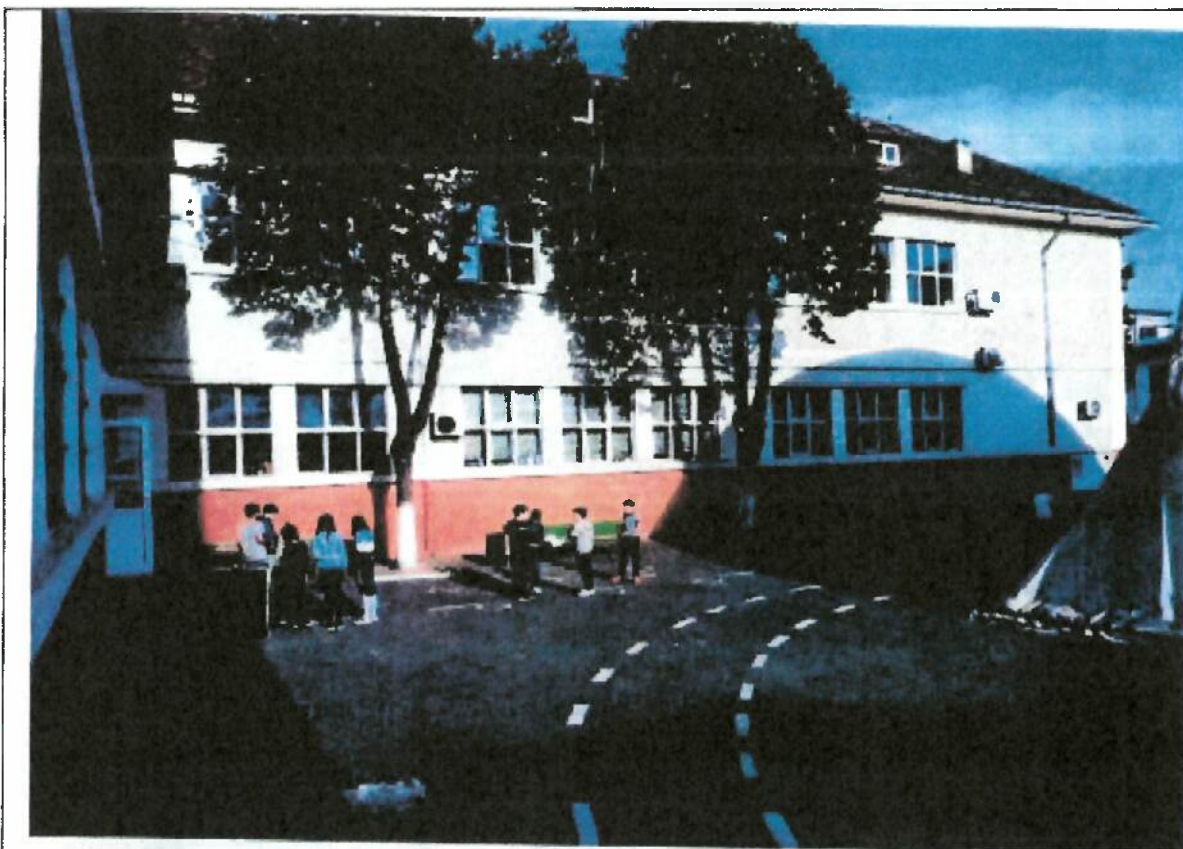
Situație existentă – Vedere laterală Corp C1 – Tronson B
